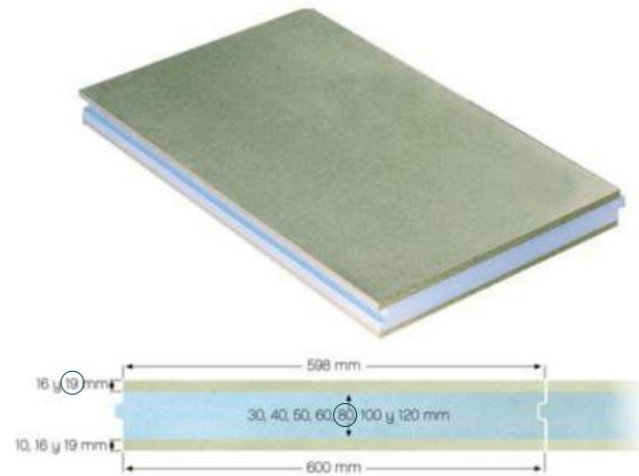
Acabado interior y exterior de cubierta: pino nacional y tejado ligero ventilado.
